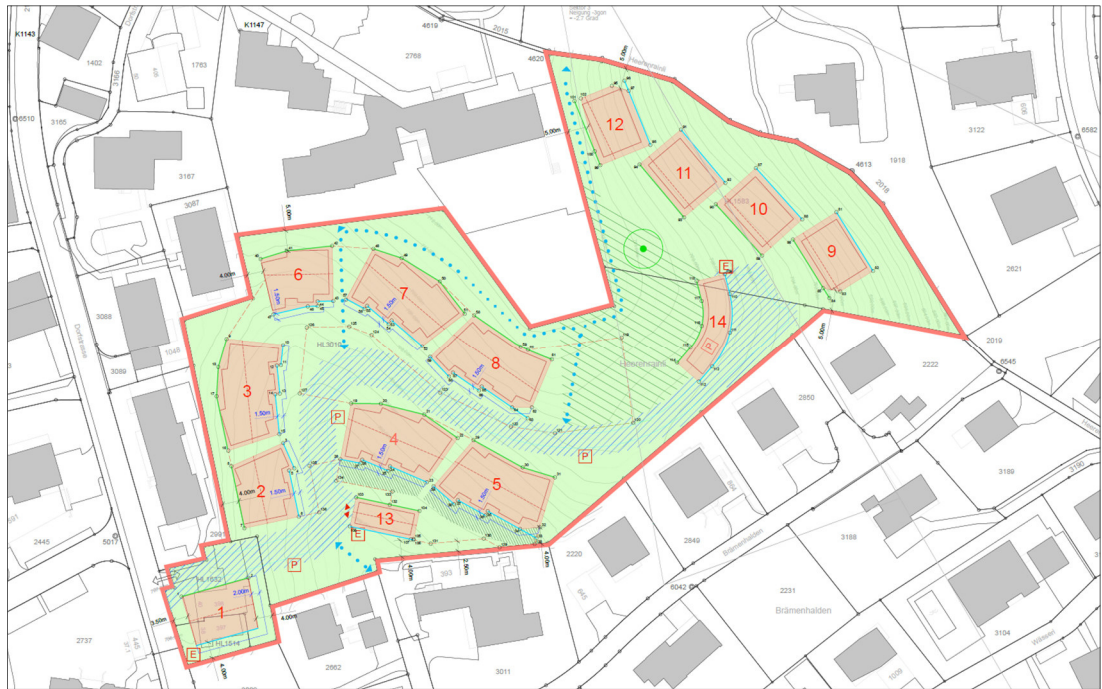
Gestaltungsplan Heerenrainli mit Nummerierung der Baubereiche
